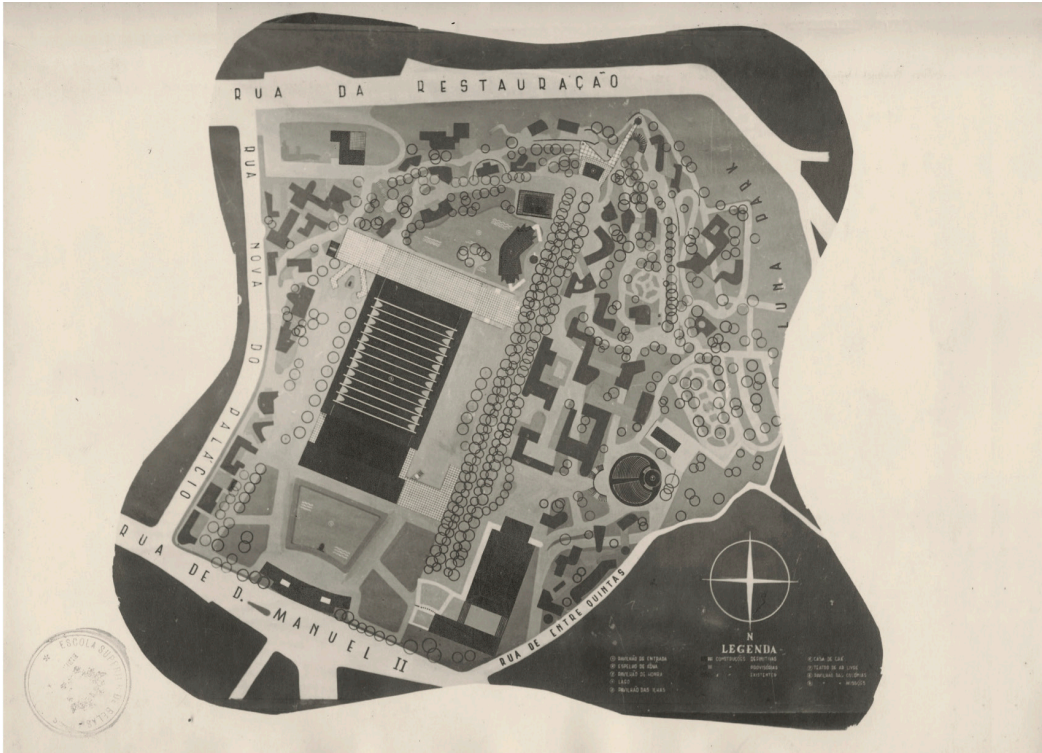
Mário Bonito, Pavilhão das Ilhas Adjacentes, planta do Plano Geral da Exposição
